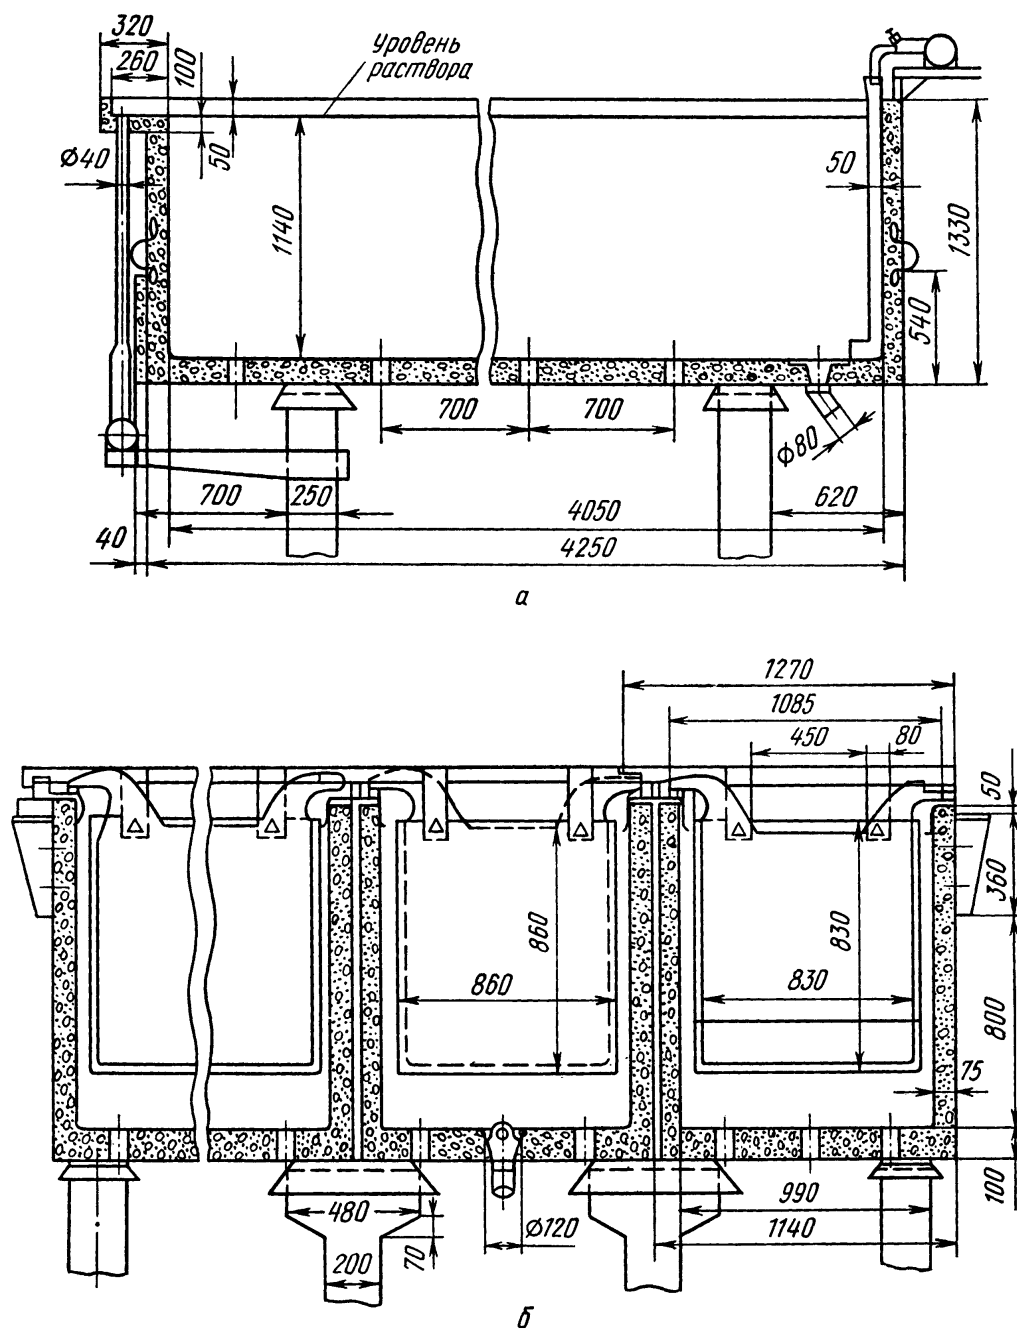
Продольный разрез железобетонной ванны для электролитического рафинирования меди (а) и поперечный разрез через блок железобетонных ванн (б)
